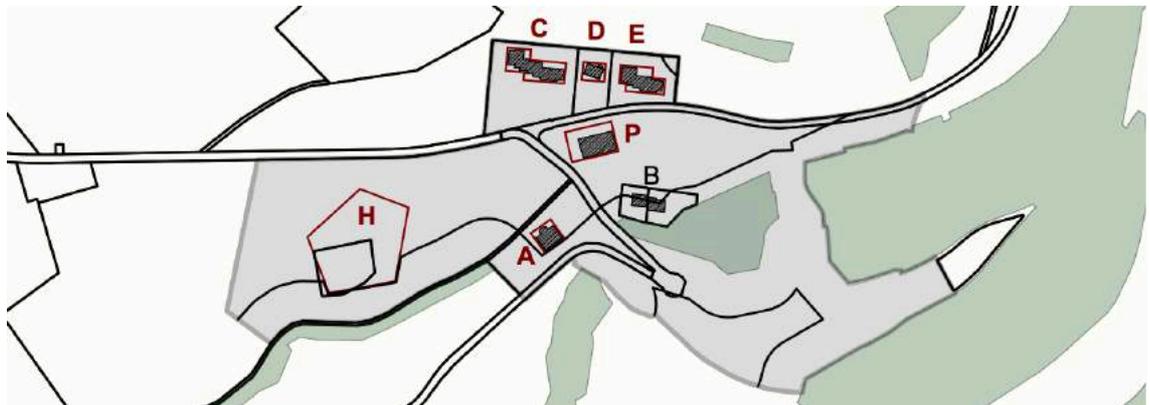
Oberirdische Baubereiche (SKW 8.5.2023)
